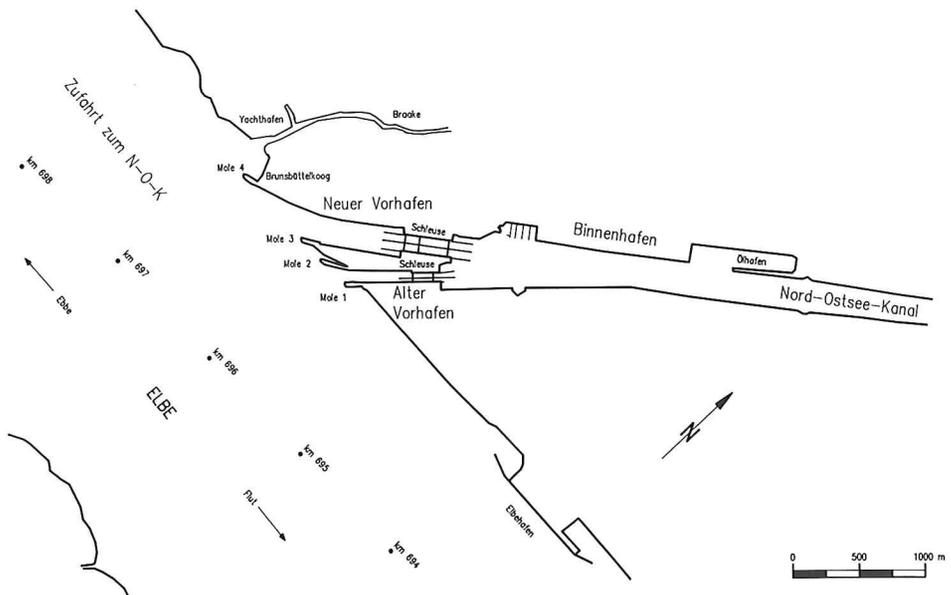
Hafenanlagen von Brunsbüttel, Lageplan
